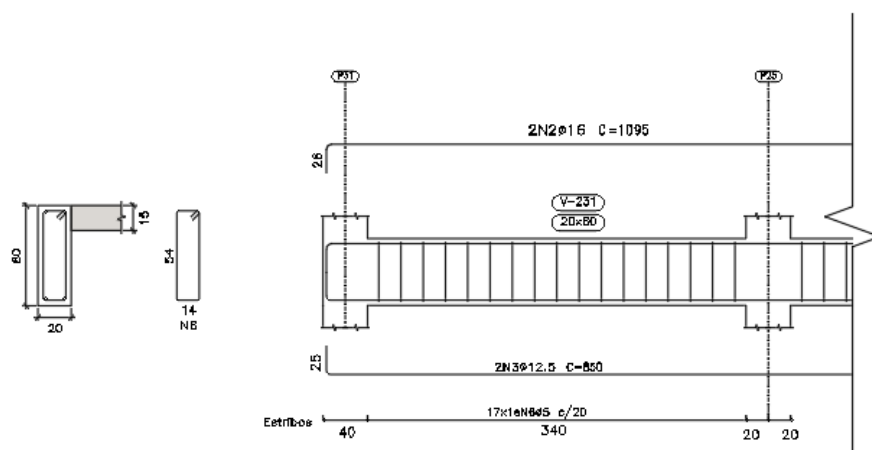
Seção transversal e longitudinal de viga de bordo
